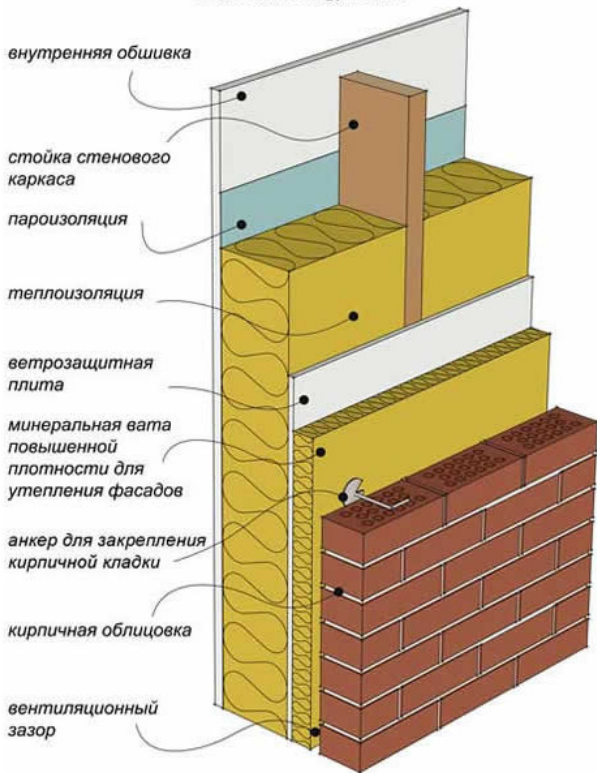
Тяжёлая наружная стена из деревянного каркаса с кирпичной наружной облицовкой
